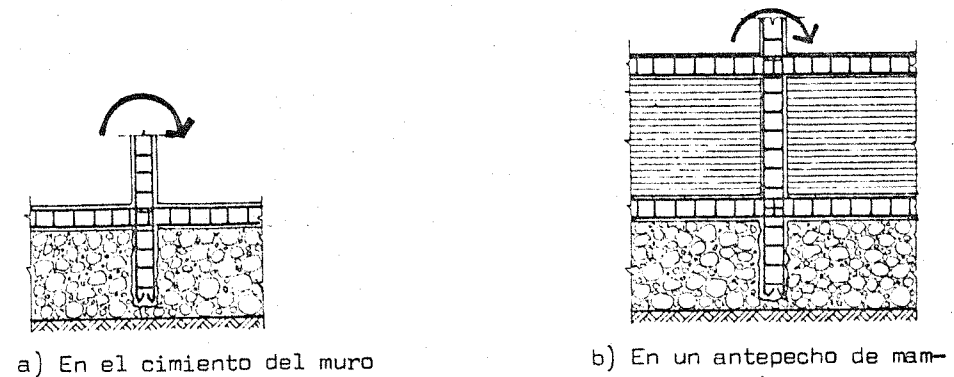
Empotramiento de columnas pequeñas en elementos constructivos
